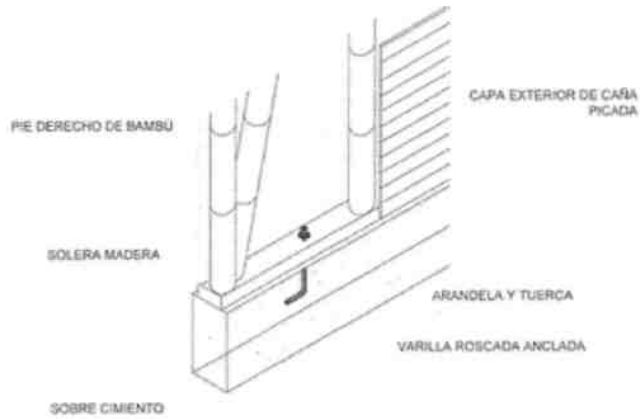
Unión muro de bahareque con solera de madera a cemento. (Ministerio de la vivienda, construcción y saneamiento del Perú, 2012)
